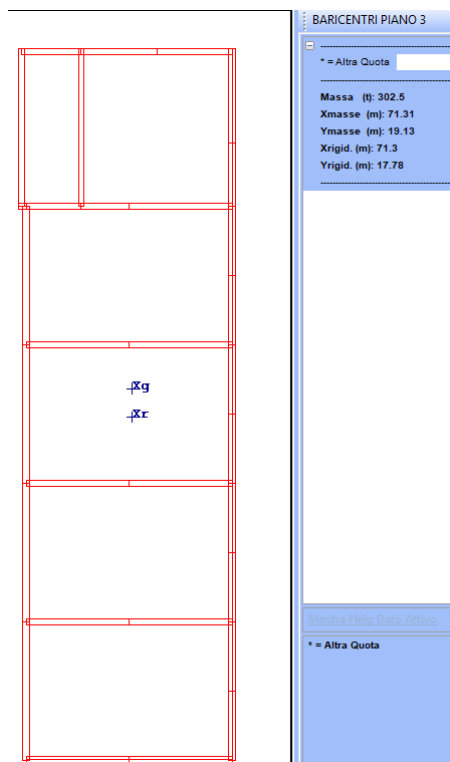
Baricentro masse e baricentro rigidezze piano terzo (piano n°3)
